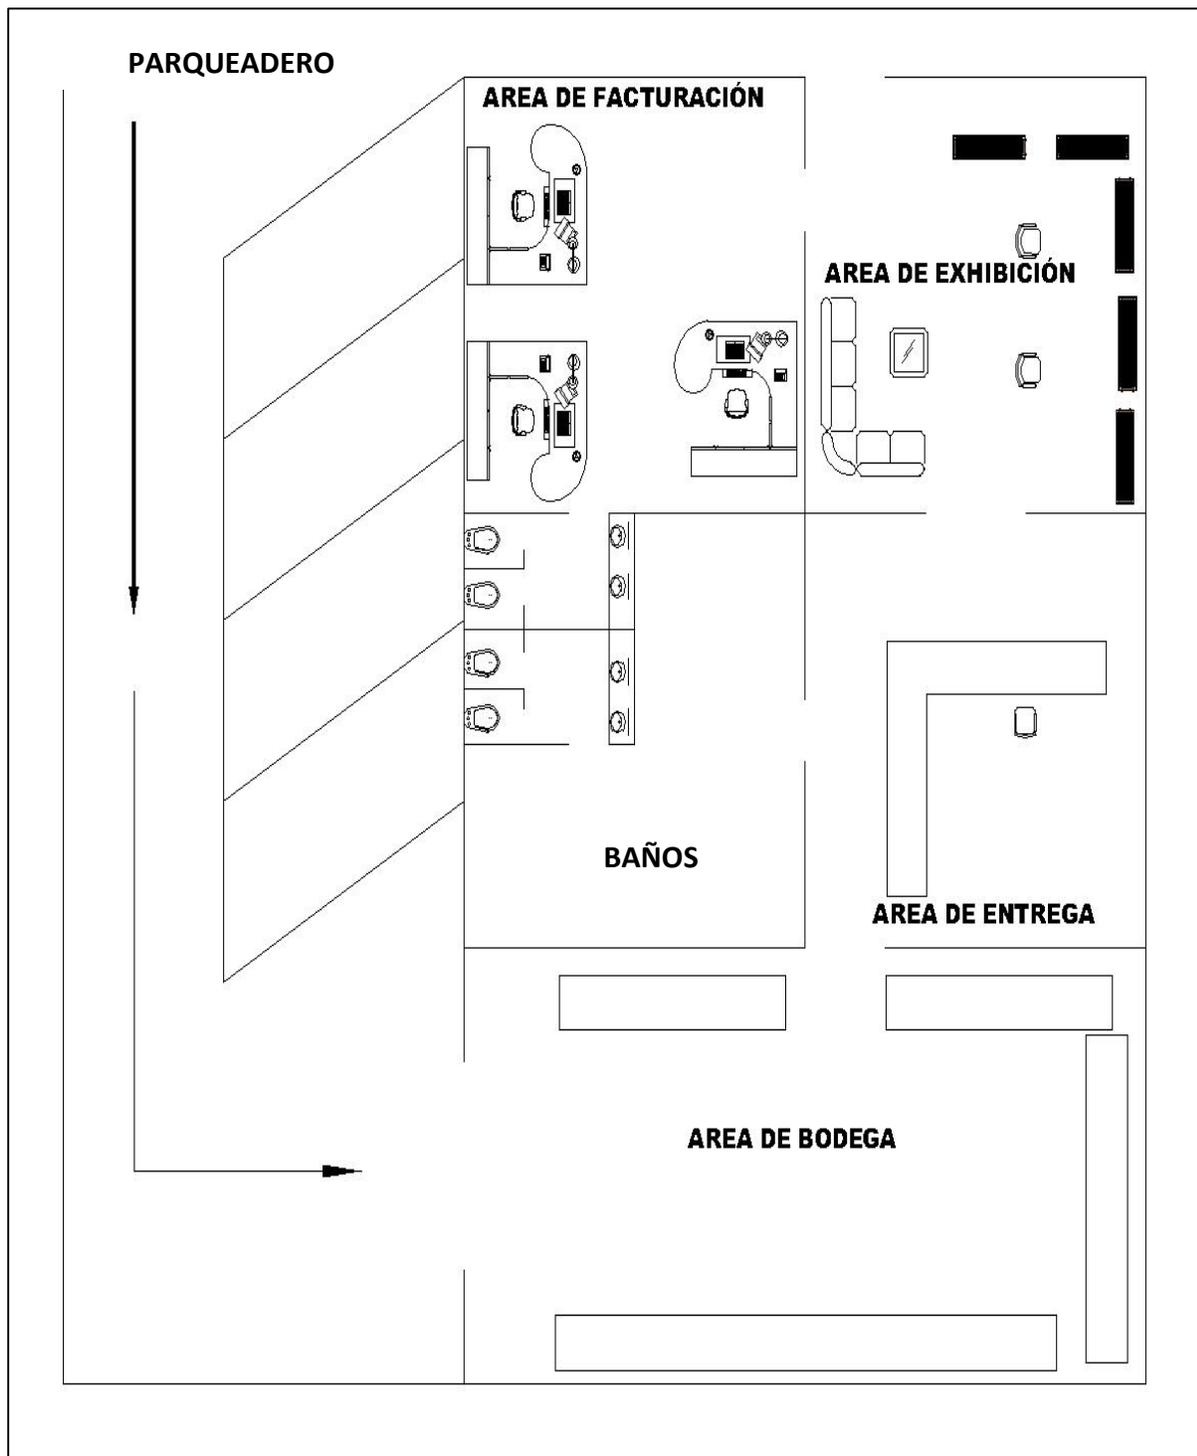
Plano de la empresa importadora de calzado "LN"
